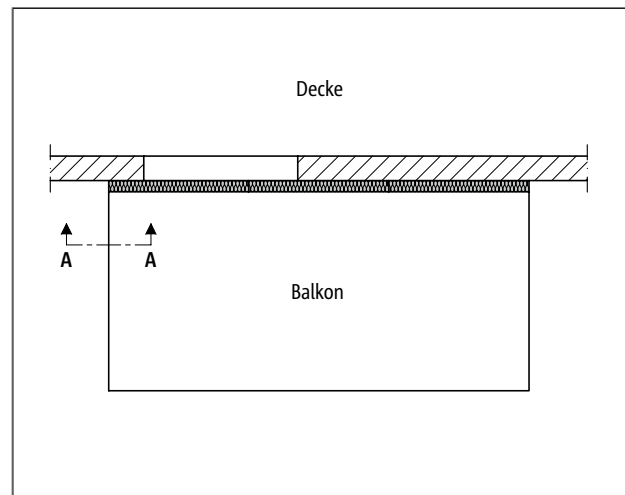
Schöck Isokorb® RT Typ K: Balkon frei auskragend
